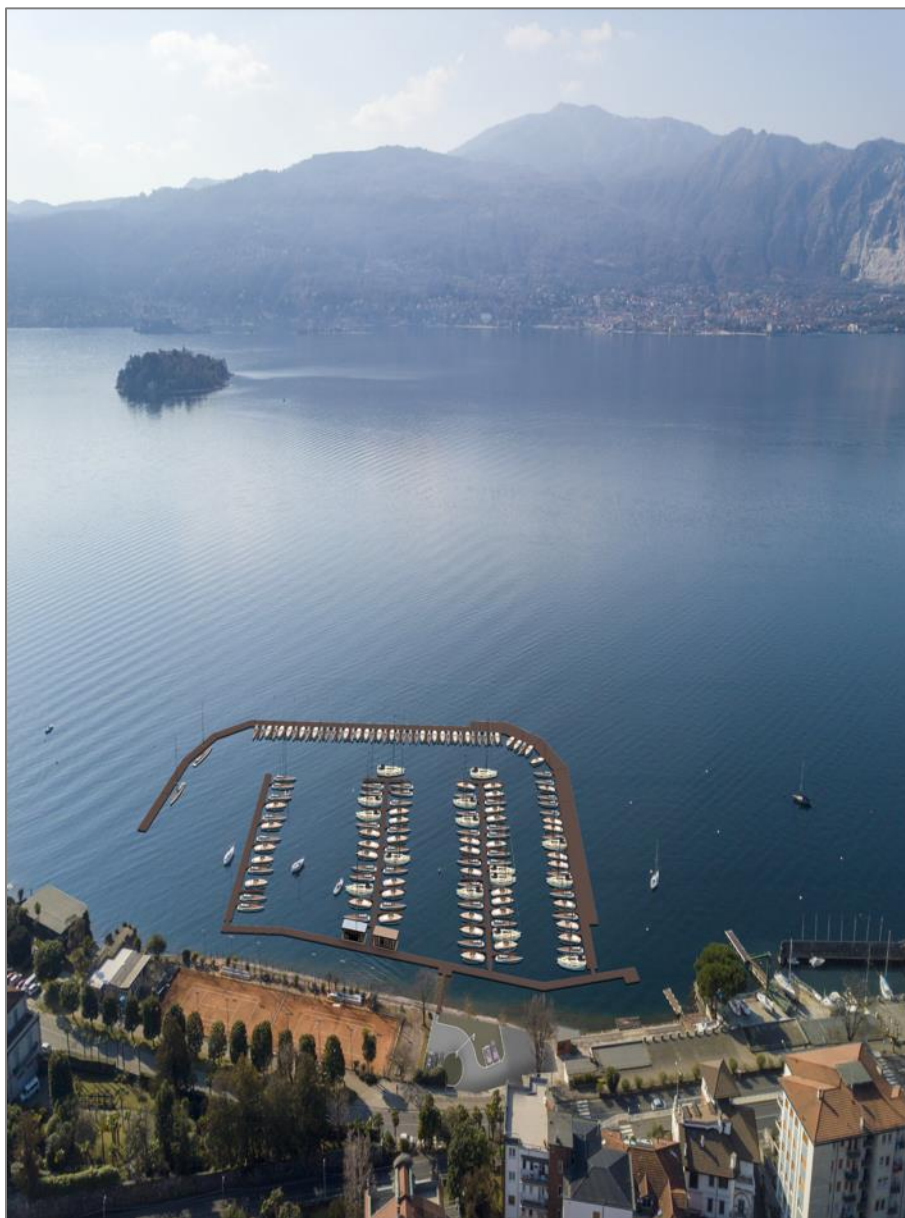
Lago Maggiore – Progetto nuovo porto Turistico di Pallanza – Fotoinserimento vista dall'alto
